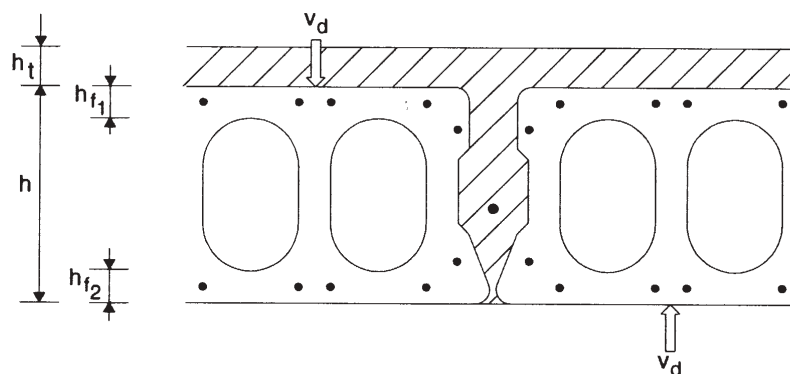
Esfuerzo cortante en las juntas entre losas alveolares pretensadas
